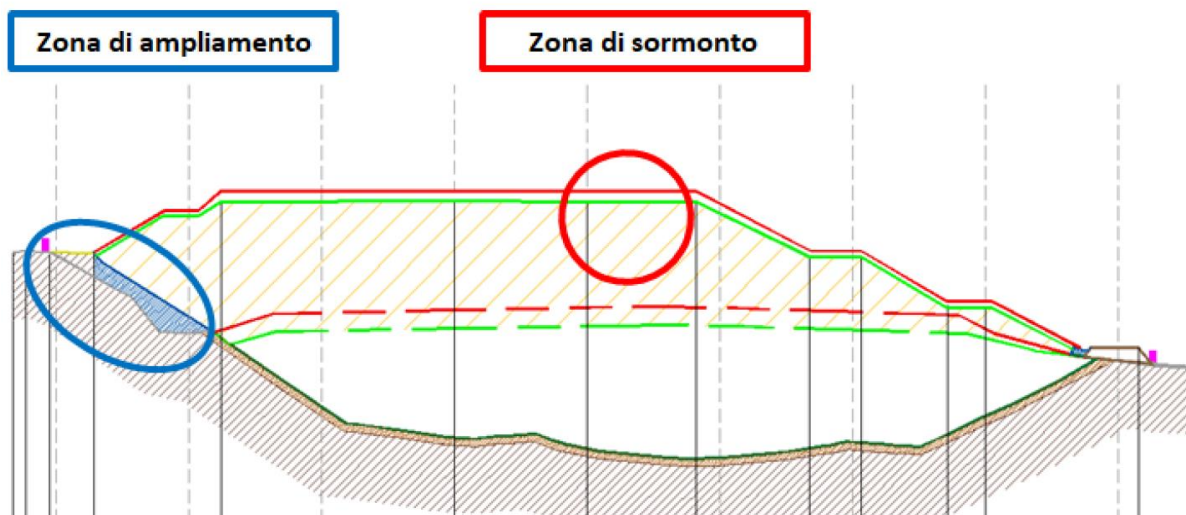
Sezione tipo con individuazione delle aree di intervento
